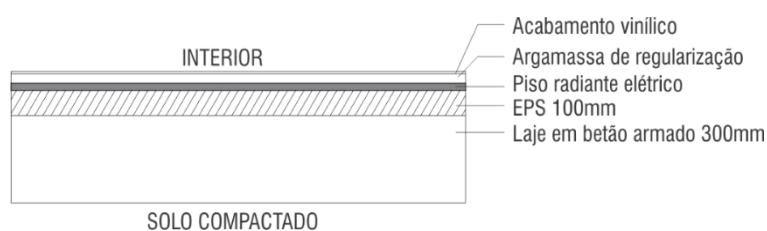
Detalhe esquemático das camadas utilizadas na configuração da laje de pavimento.
